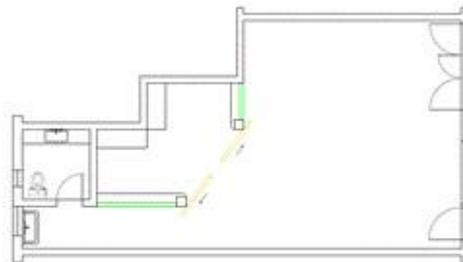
Terceira proposta, com área de armazenamento isolada com dois cortinados e uma parede falsa de pilar a pilar, cortinas a vermelho e parede falsa a laranja. Fonte: Autor
